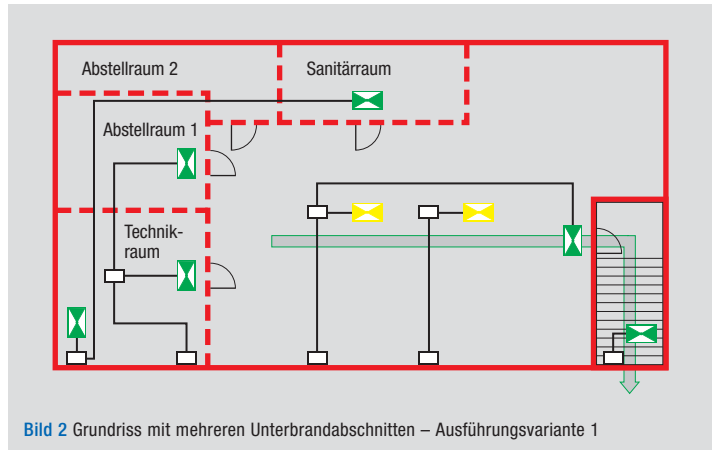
Grundriss mit mehreren Unterbrandabschnitten – Ausführungsvariante 1
